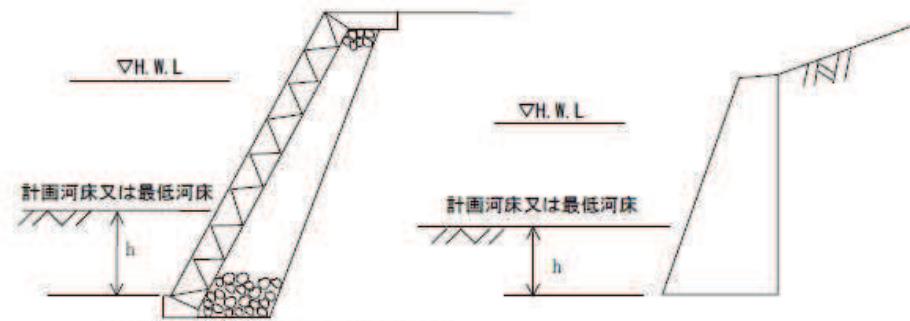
護岸の根入れ（砂礫地盤の場合）
